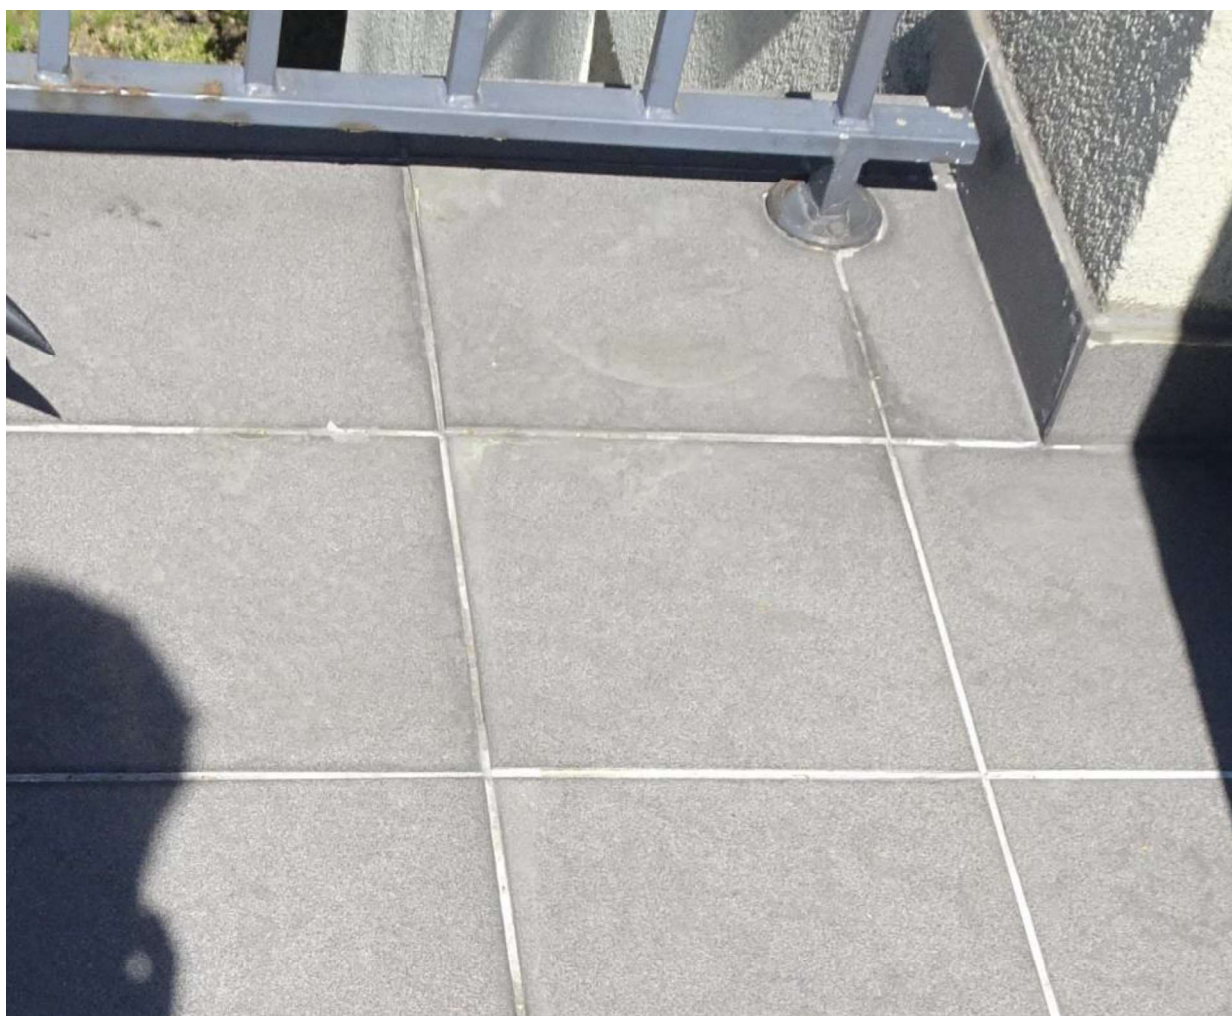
Lokalizacja odkrywki punktowej przyłączeniu krawędzi balkonu z elewacją.
